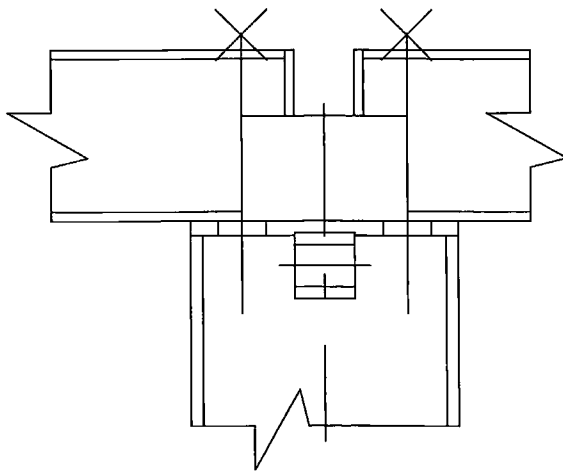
# DETAILY HORNÍHO PRŮBĚŽNÉHO ZTUŽENÍ
